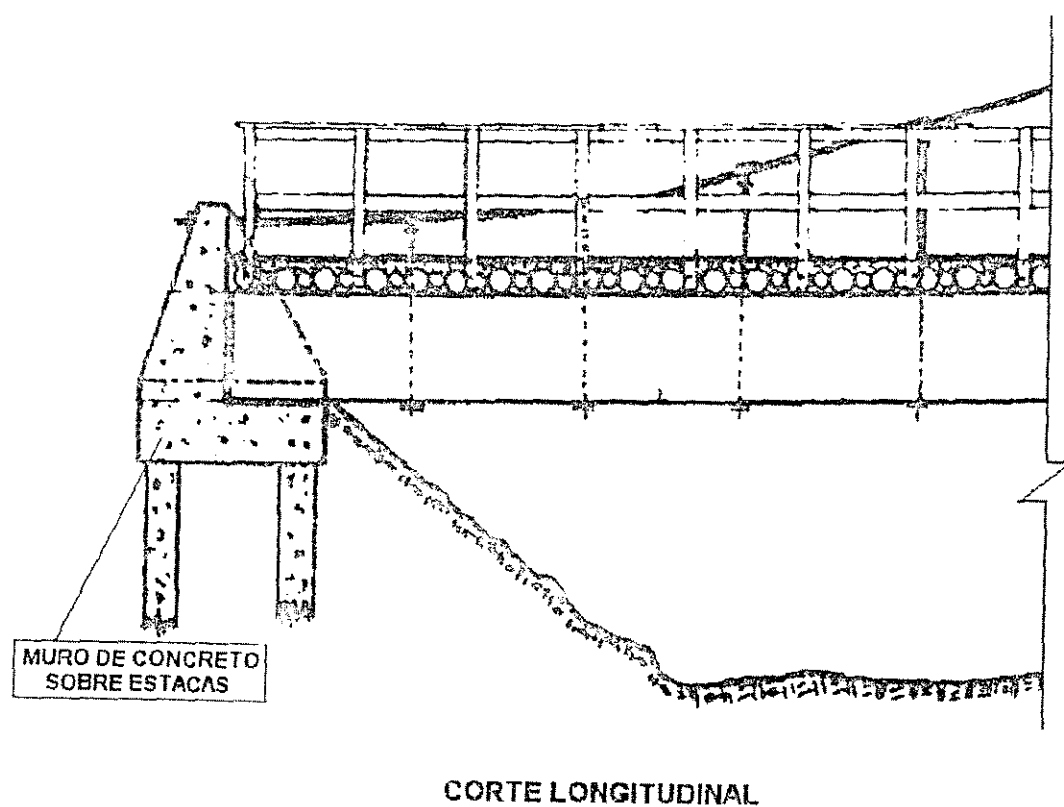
Fundação utilizando muro de concreto sobre estacas.
